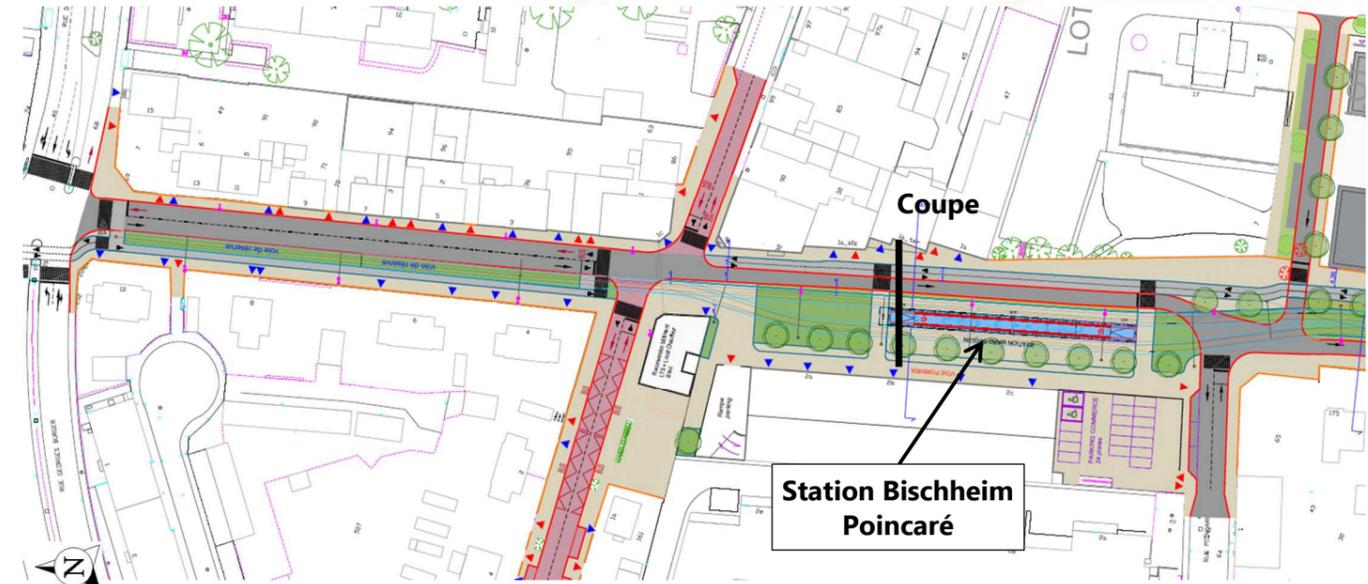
Plan route du général de Gaulle -station terminus (source : AVP, GETAS 2023)
